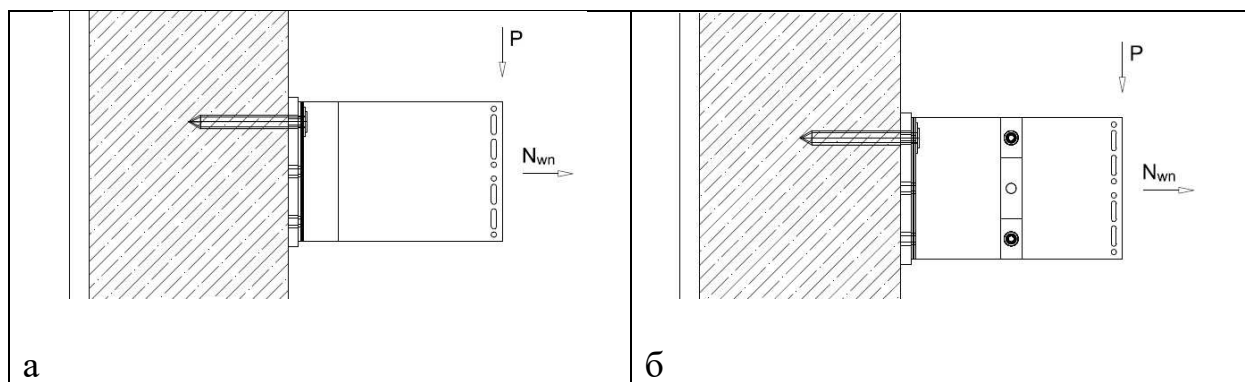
Расчетные схемы действия нагрузок на несущие кронштейны
